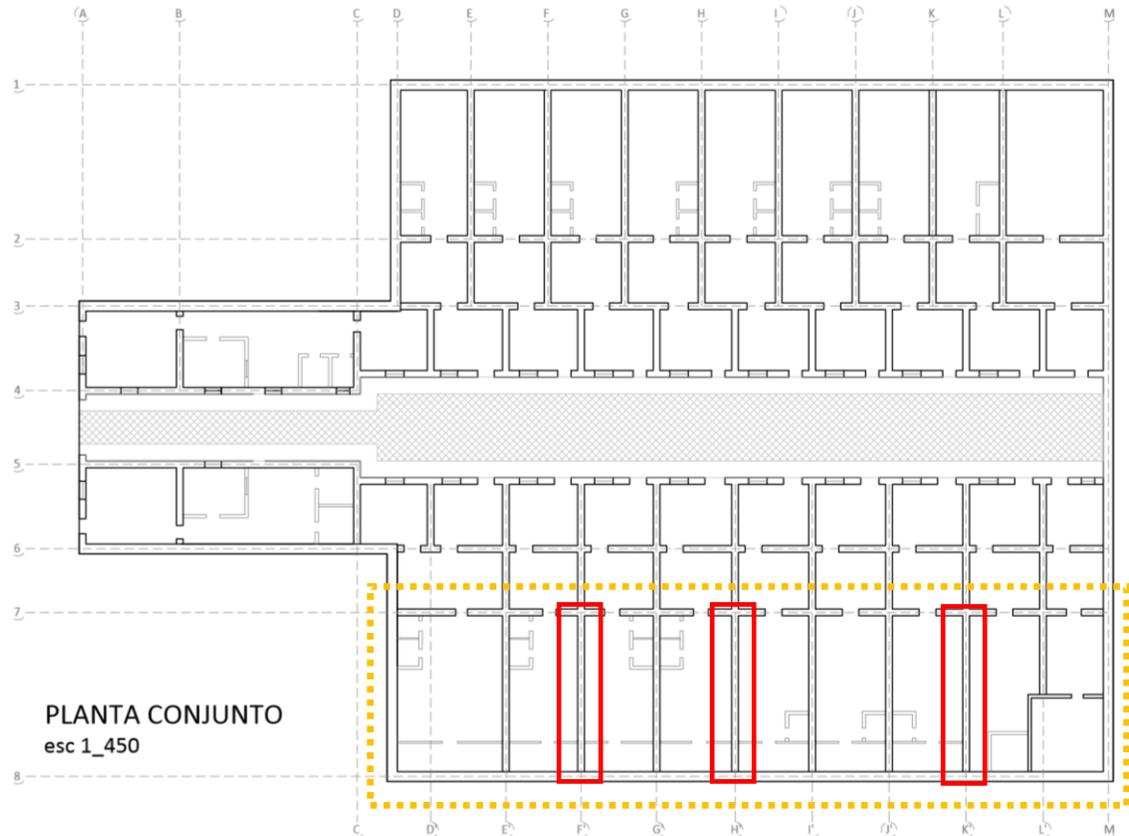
Plano de conjunto intervenido donde se indican en color rojo los muros más propensos.
